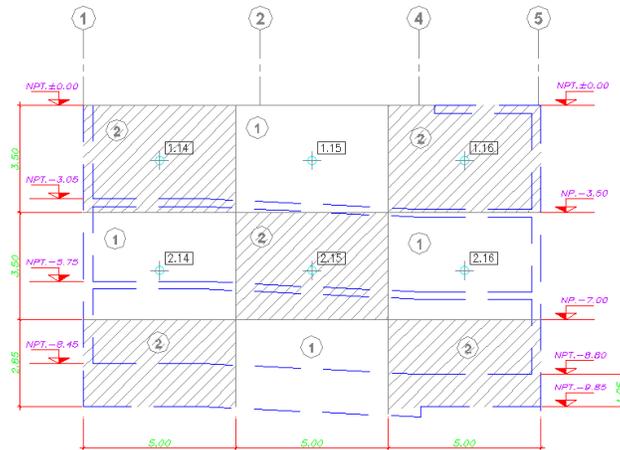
°.- Detalle de Corte 14-14 – Nivel de Cimentación.
